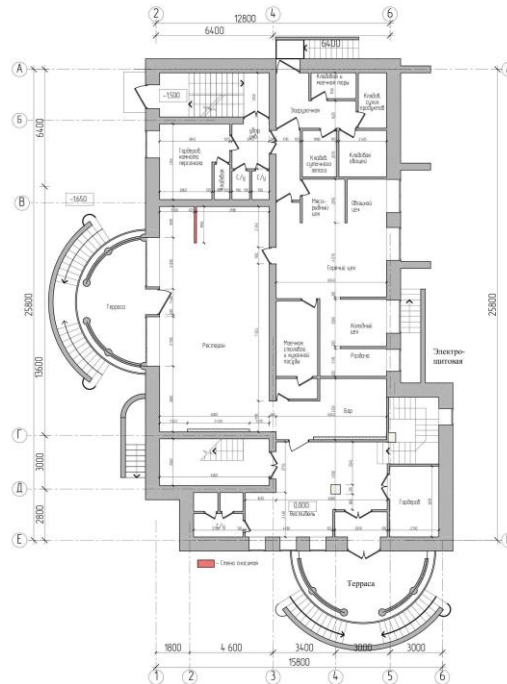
План 1-го этажа (ресторан и бар)
